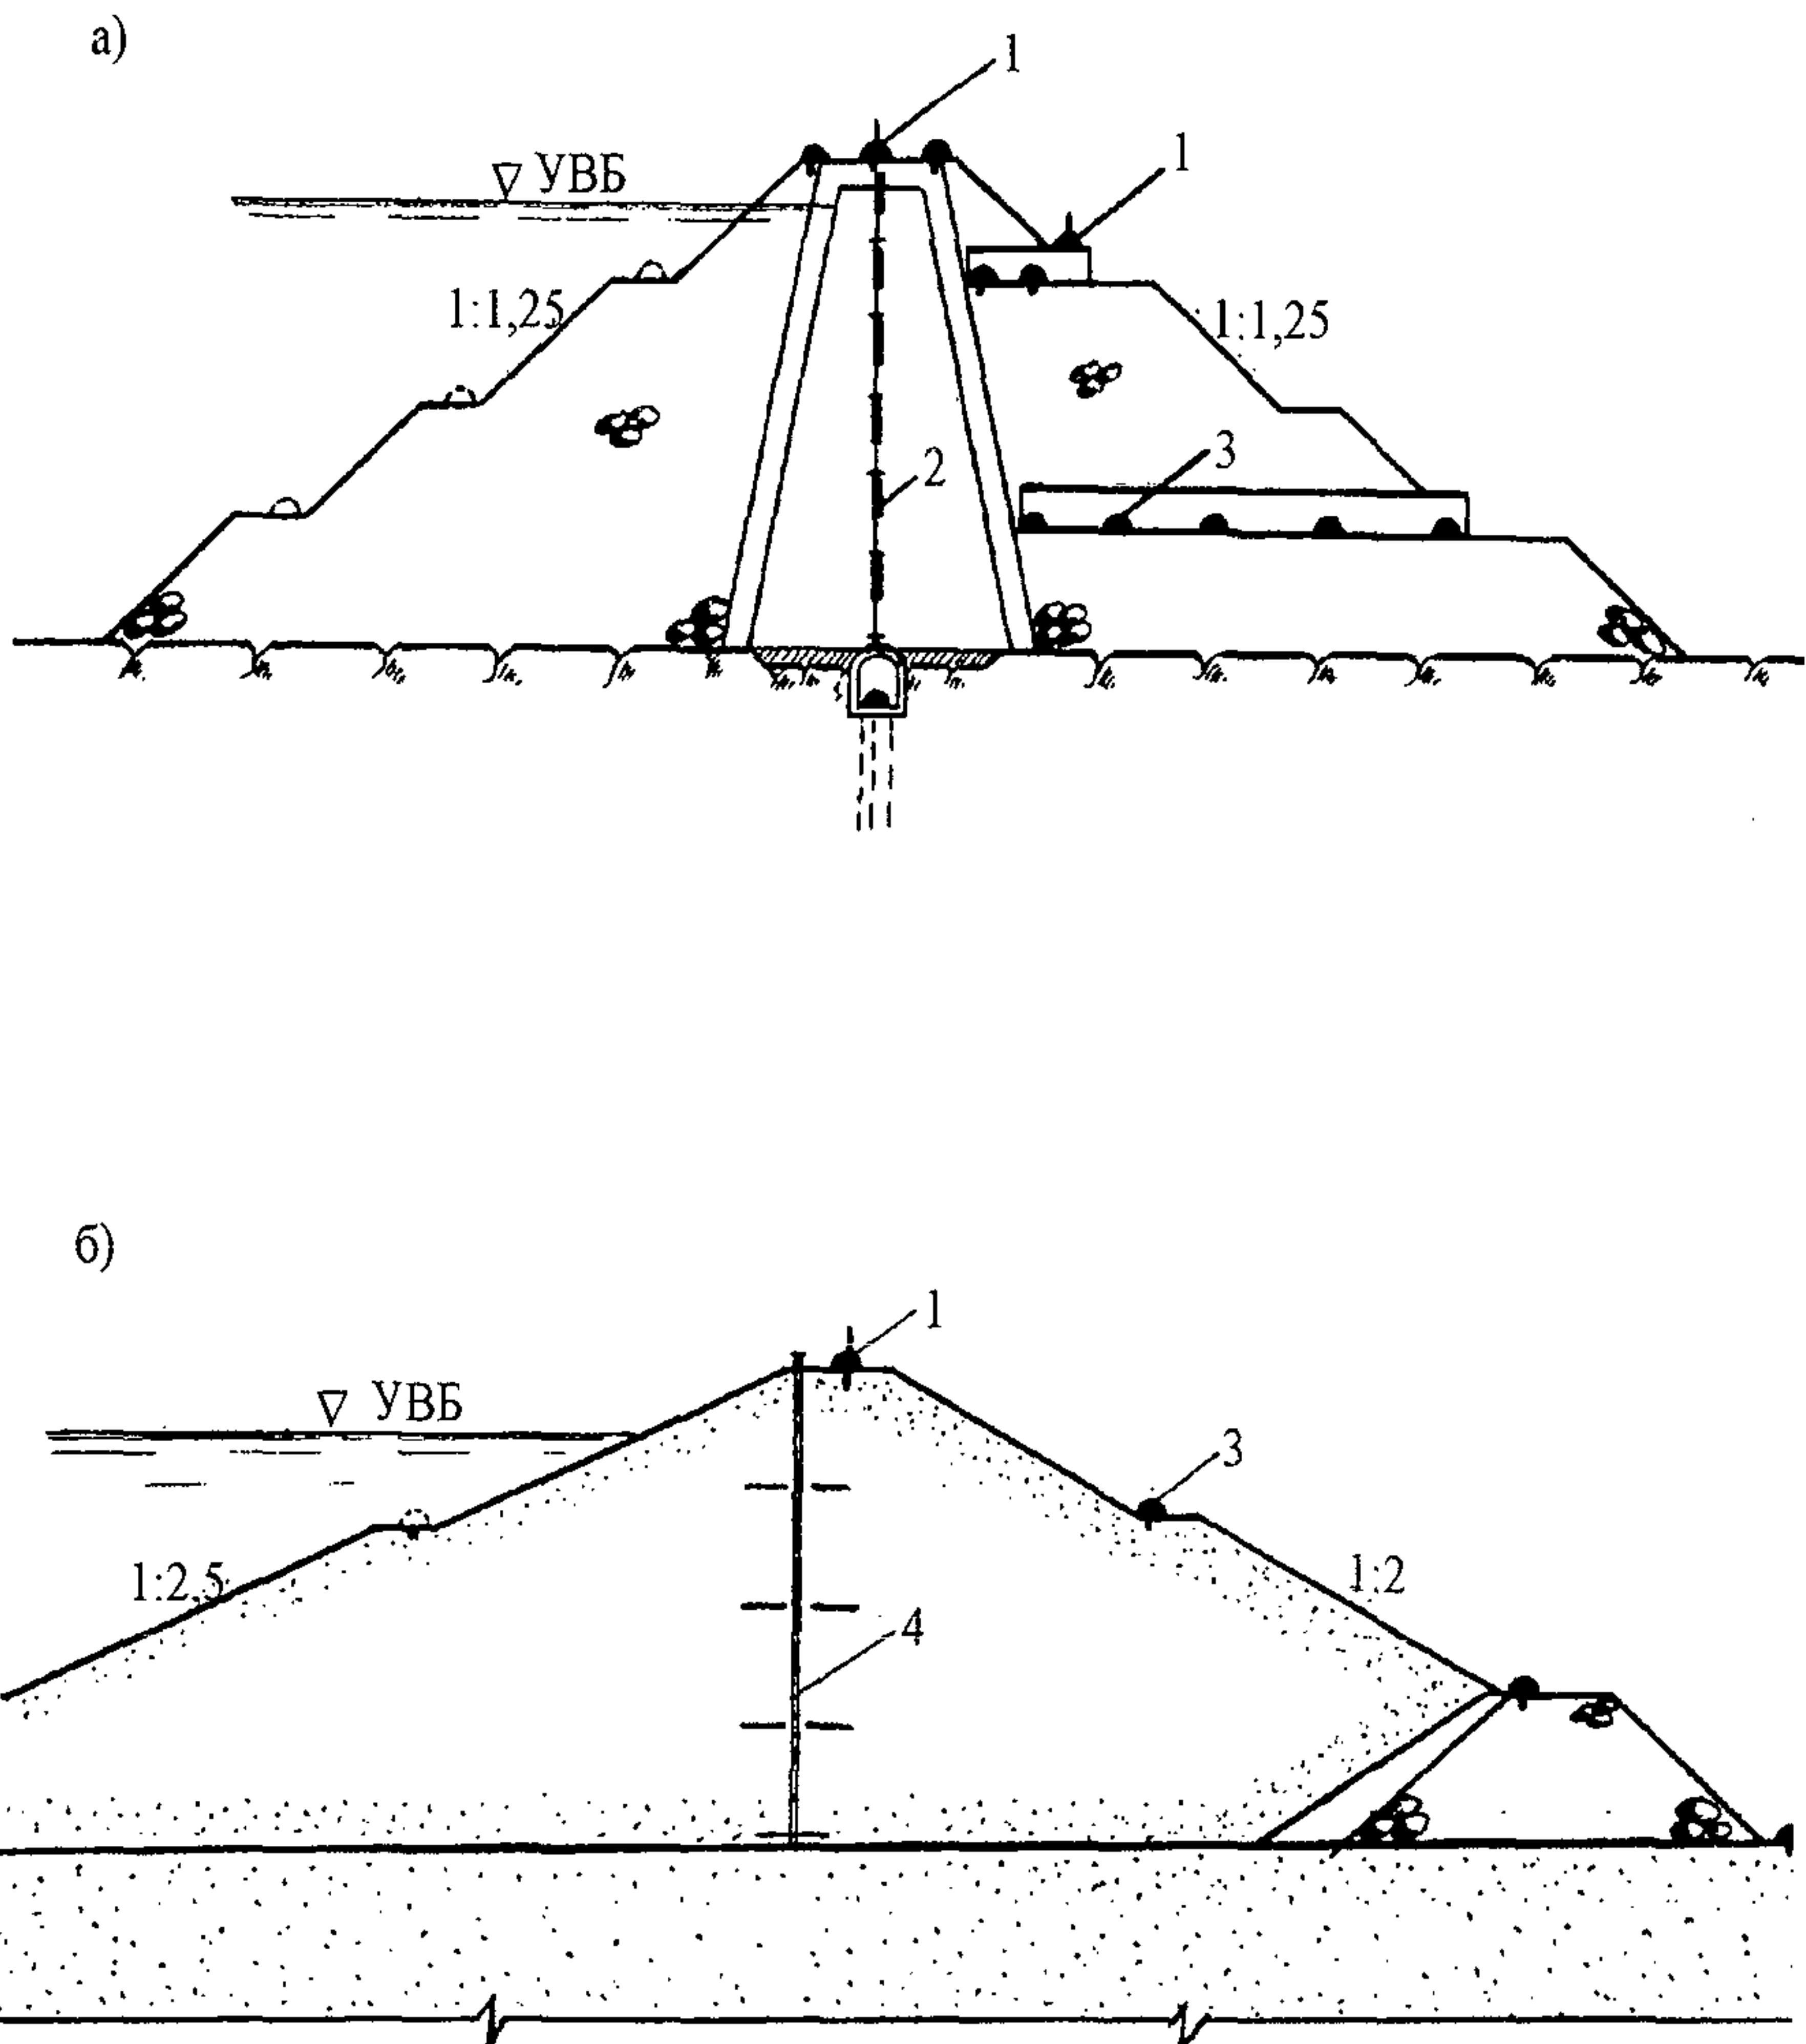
Принципиальные схемы размещения геодезических марок на грунтовых плотинах:
